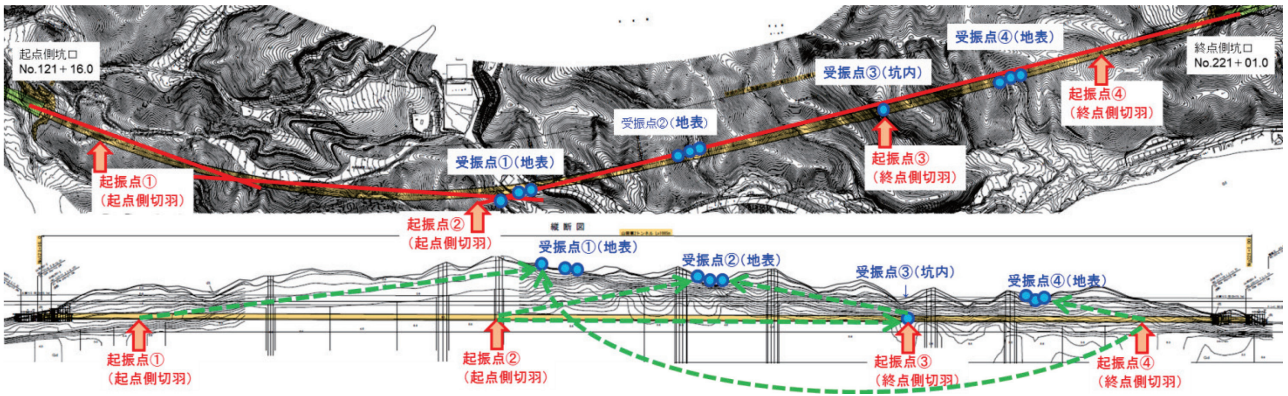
起振点および受振点位置図および対応関係 (平面図, 縦断面図)
